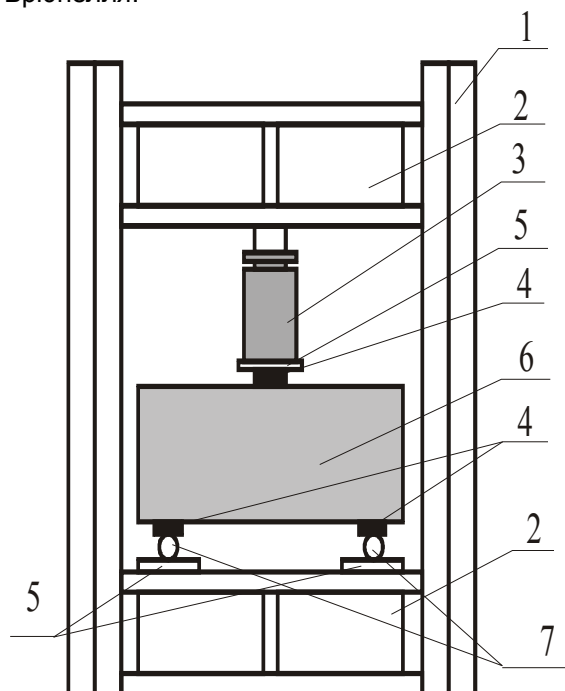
Схема силовой установки испытания образцов-балок: 1 – металлическая рама; 2 – распределительная траверса; 3 – гидродомкрат; 4 – опорные площадки; 5 – жесткий штамп; 6 – испытываемый образец; 7 – катки
